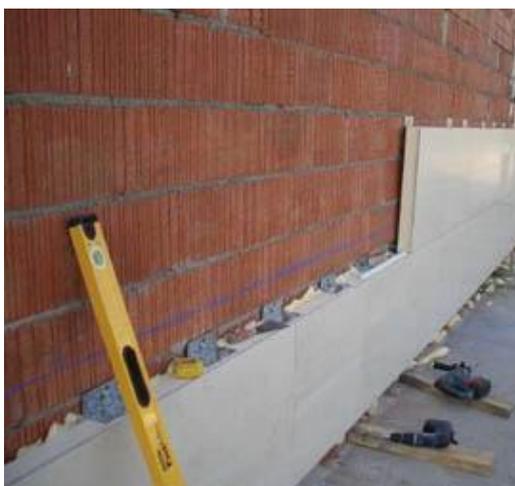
Esquema de instalación de aislamiento por el exterior de fachada con XPS
